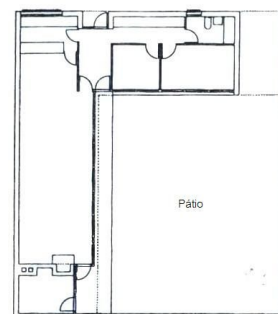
Jorn Utzon, Planta duma unidade das Kingo Houses.
